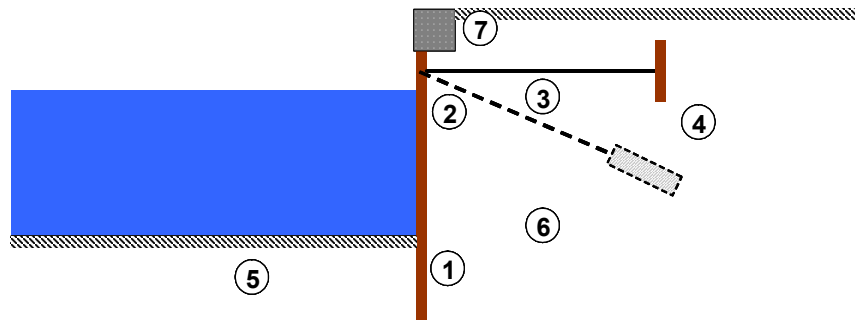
Décomposition en éléments structurels d'un quai constitué par un écran de soutènement en palplanches.
